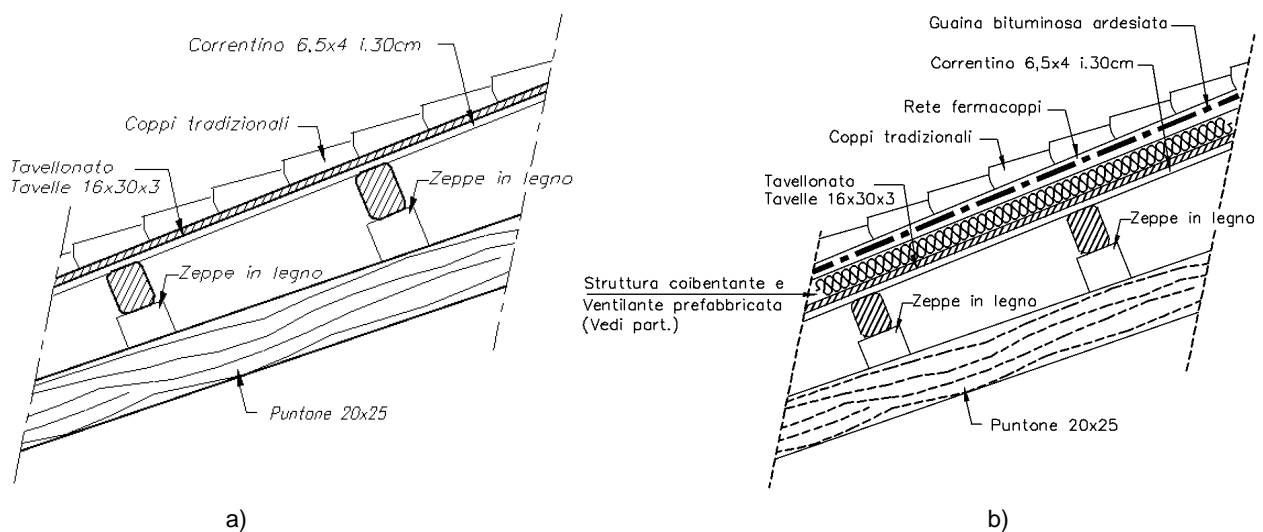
Ex-Lavanderie - pacchetti di copertura: a) stato di fatto, b) stato di progetto
